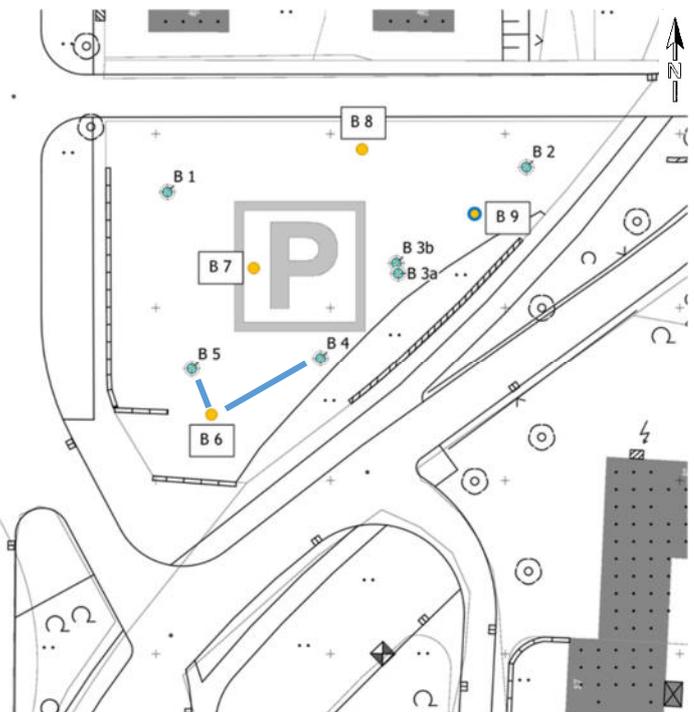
Bohrprofile und Lageplan der Bohransatzpunkte
